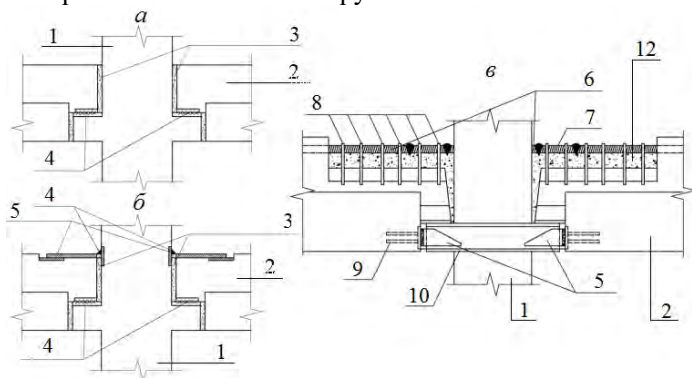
Конструктивное решение стыка ригеля с колонной в зданиях каркасно-балочной конструктивной системы: а – шарнирный узел, б – полужесткий, в – жесткий. 1 – колонна, 2 – ригель. 3 – бетон омоноличивания, 4 – сварные швы, 5 – соединительные пластины, 6 – арматурные выпуски из ригеля и колонны, 7 – вставка арматуры, 8 – хомуты, 9 – закладная деталь ригеля, 10 – закладная деталь консоли колонны.
